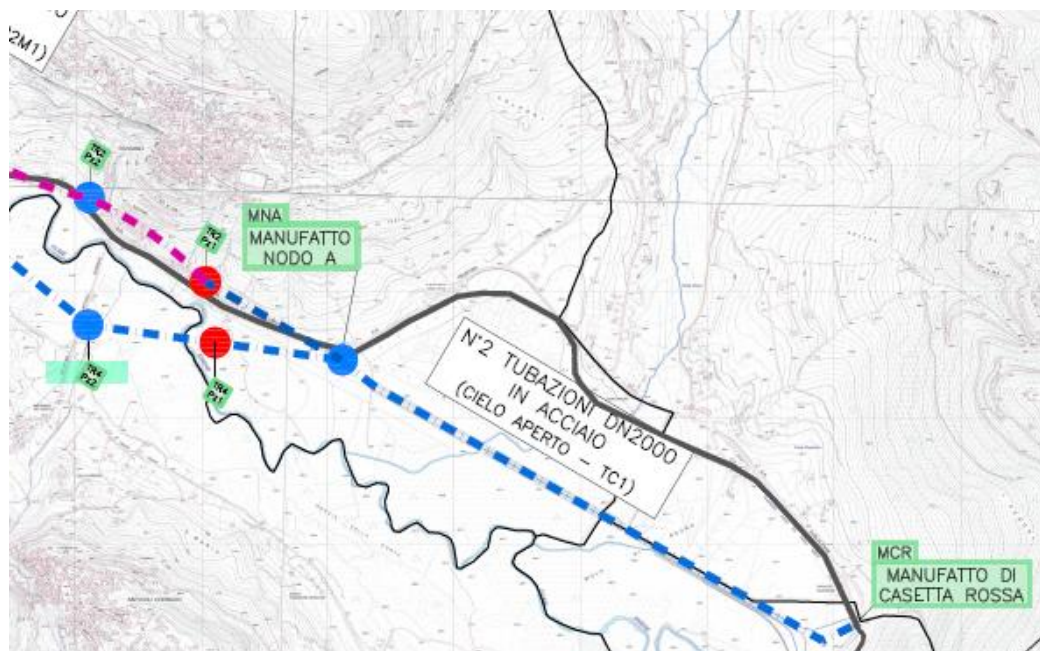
Planimetria della prima fase funzionale (in blu) del Nuovo Acquedotto Marcio
